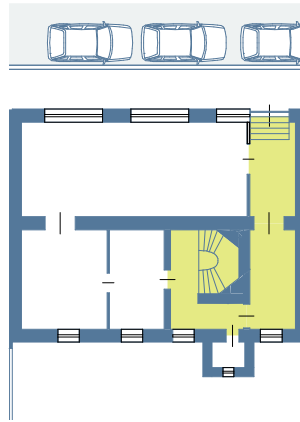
Grundriss eines Gründerzeithauses mit einer Erschließung über einen seitlichen Eingang
